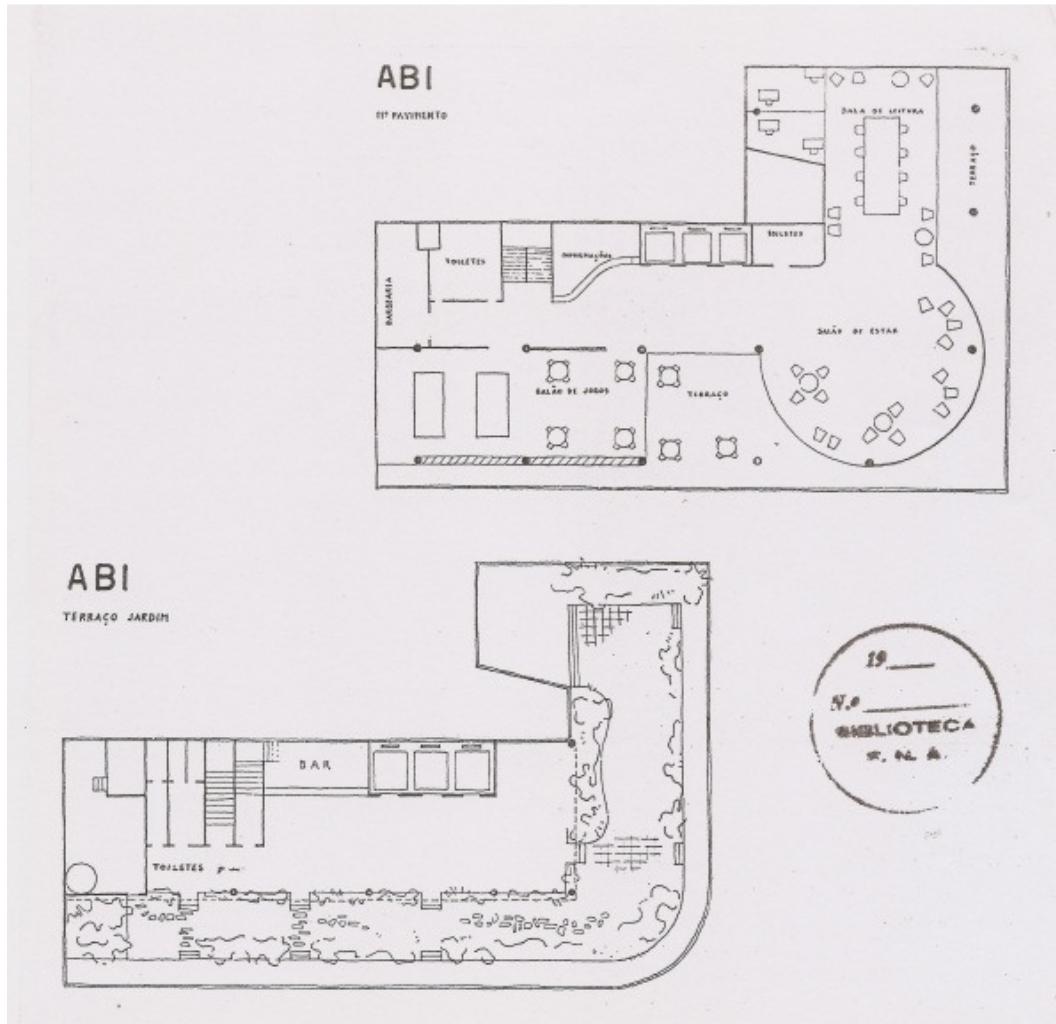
I – Plantas baixas do décimo primeiro pavimento (áreas de estar) e do décimo segundo pavimento (terraço-jardim e restaurante)
